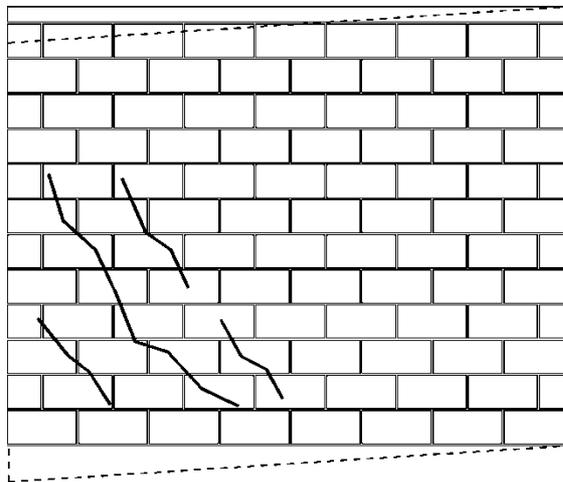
Recalques diferenciados entre pilares: surgem trincas inclinadas na direção de maior recalque.
